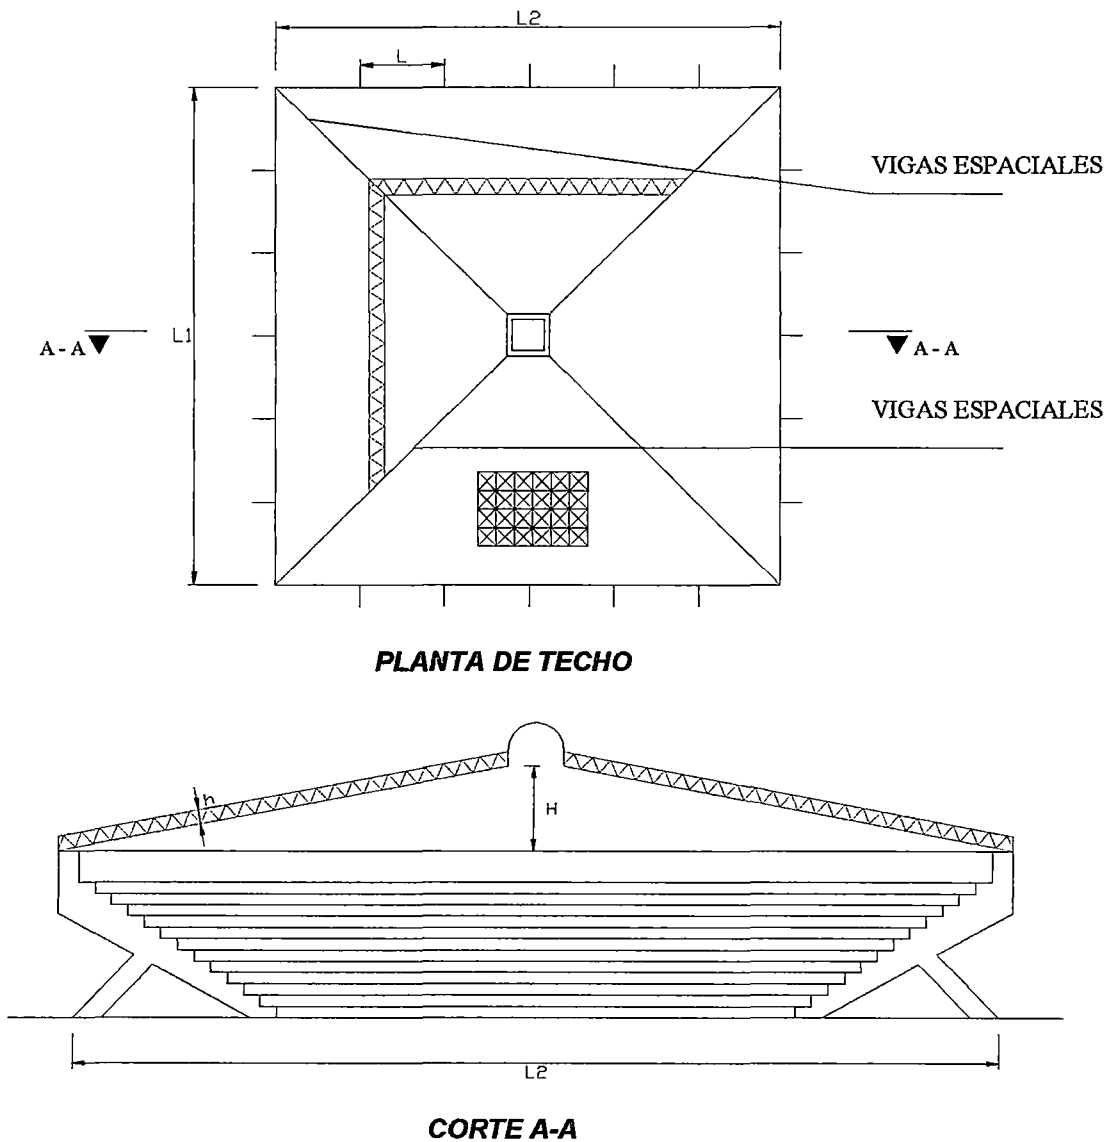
Vista en Planta y Elevación Típicas de un Techo a Cuatro Aguas
